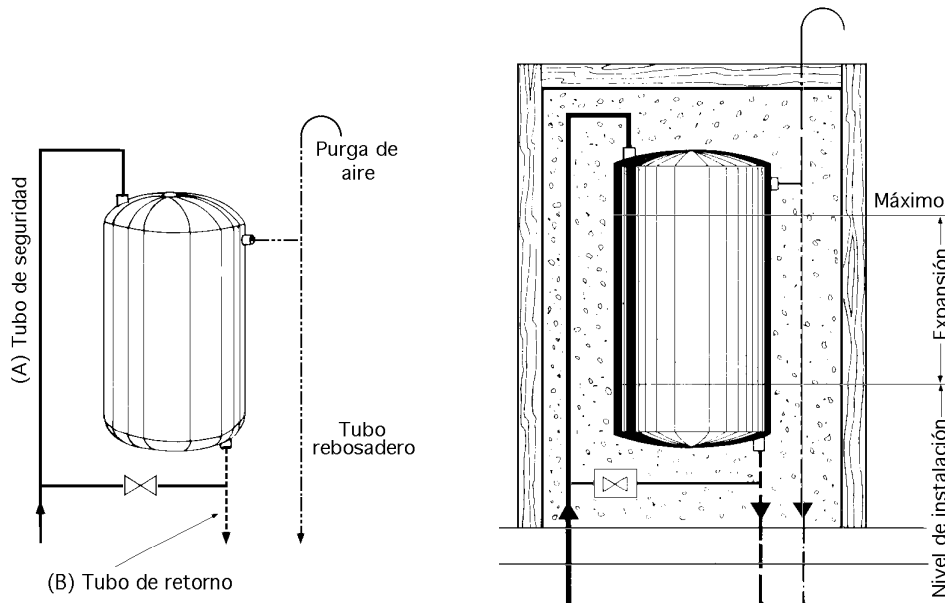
Tuberías conectadas a un depósito de expansión y aislamiento
